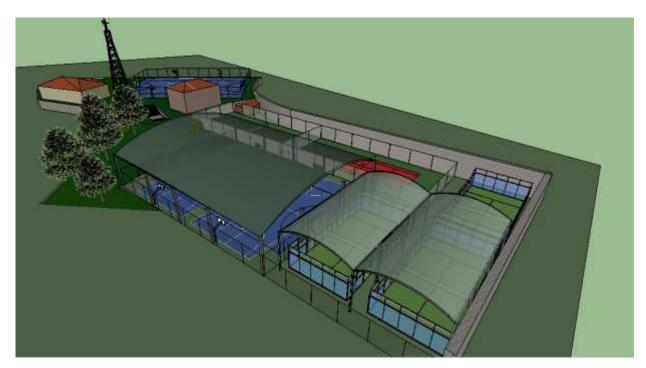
Propuesta de distribución para las pistas deportivas exteriores incorporando cubiertas modelado con SketchUp
